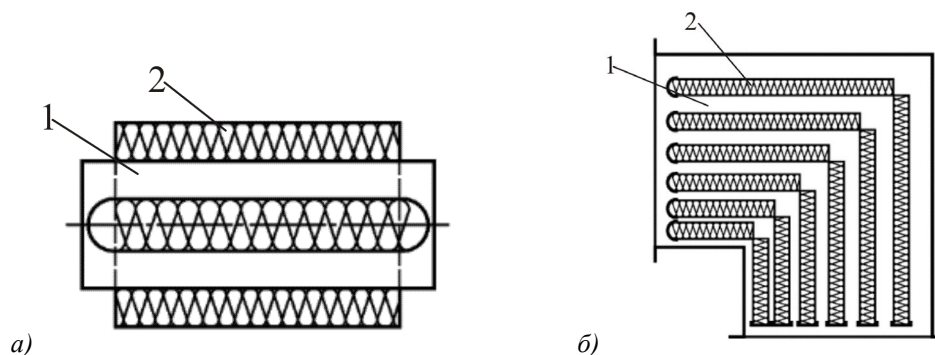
Глушитель: а) круглый глушитель с концентрическим кожухом; б) коленчатый глушитель.
